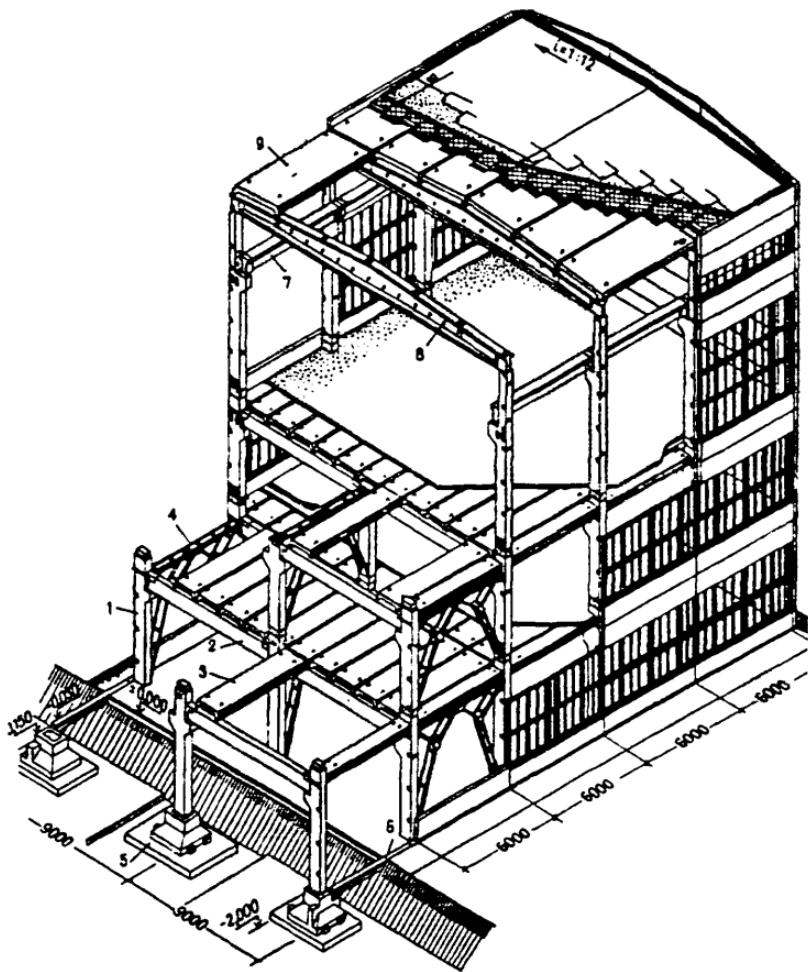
Полный сборный железобетонный каркас многоэтажного промышленного здания с перекрытиями балочного типа:
